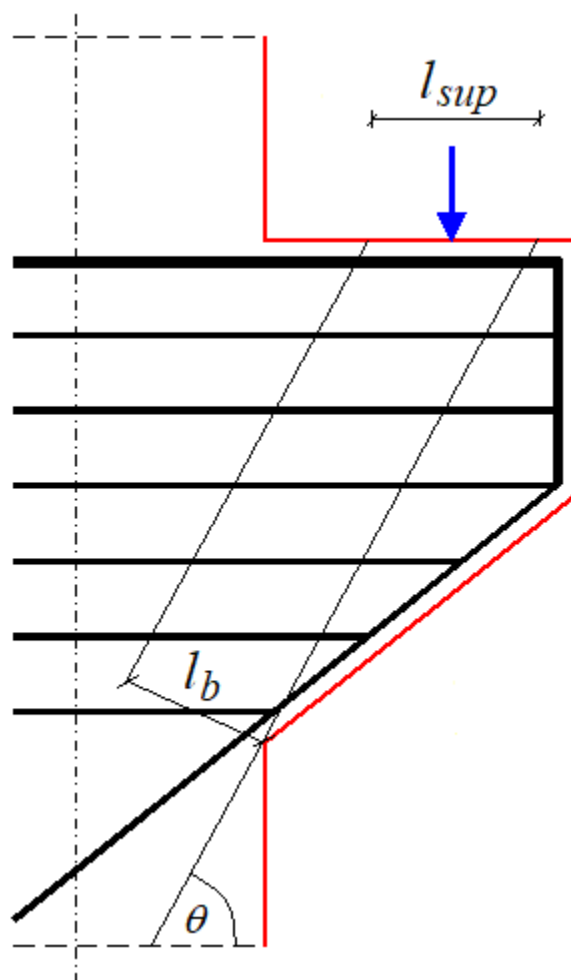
Схема консоли с горизонтальной поперечной арматурой
